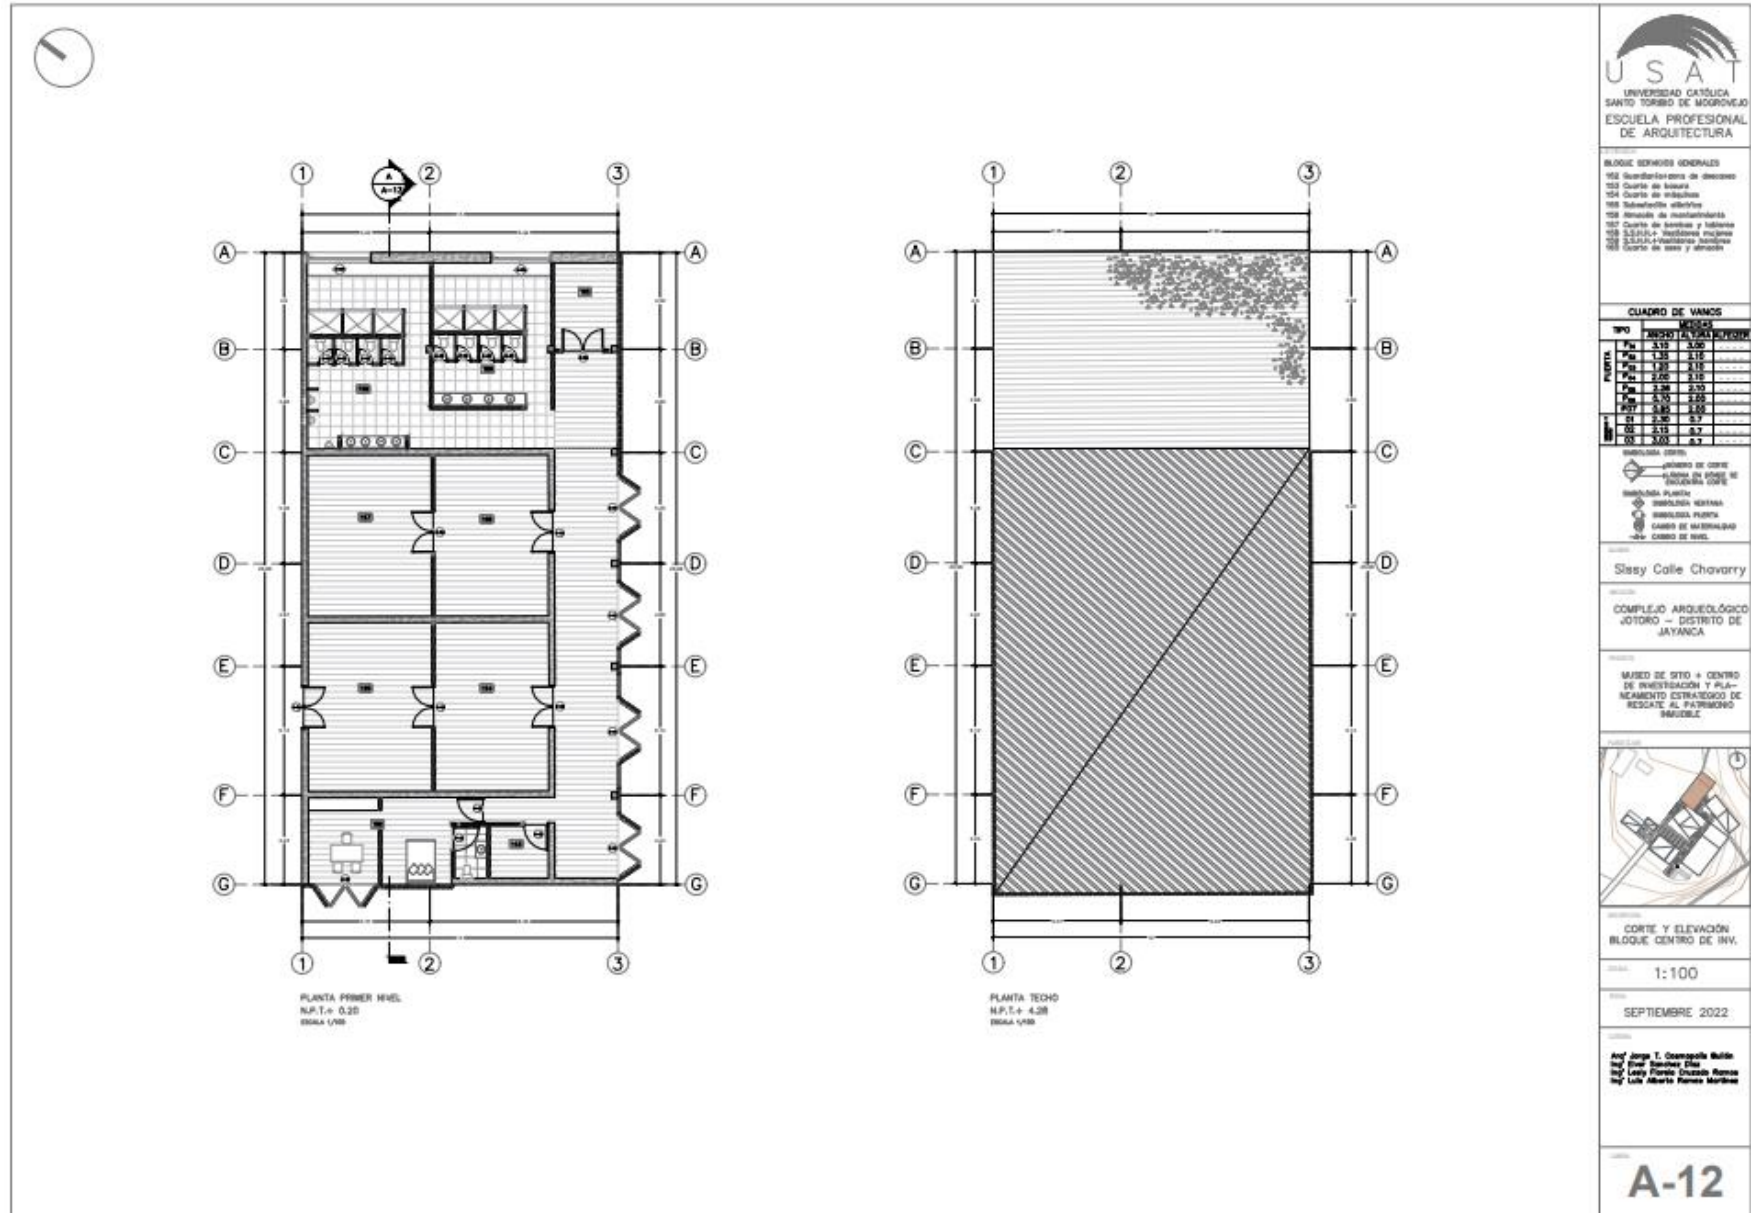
Planos de detalle bloque de servicios generales. Fuente: Propia
